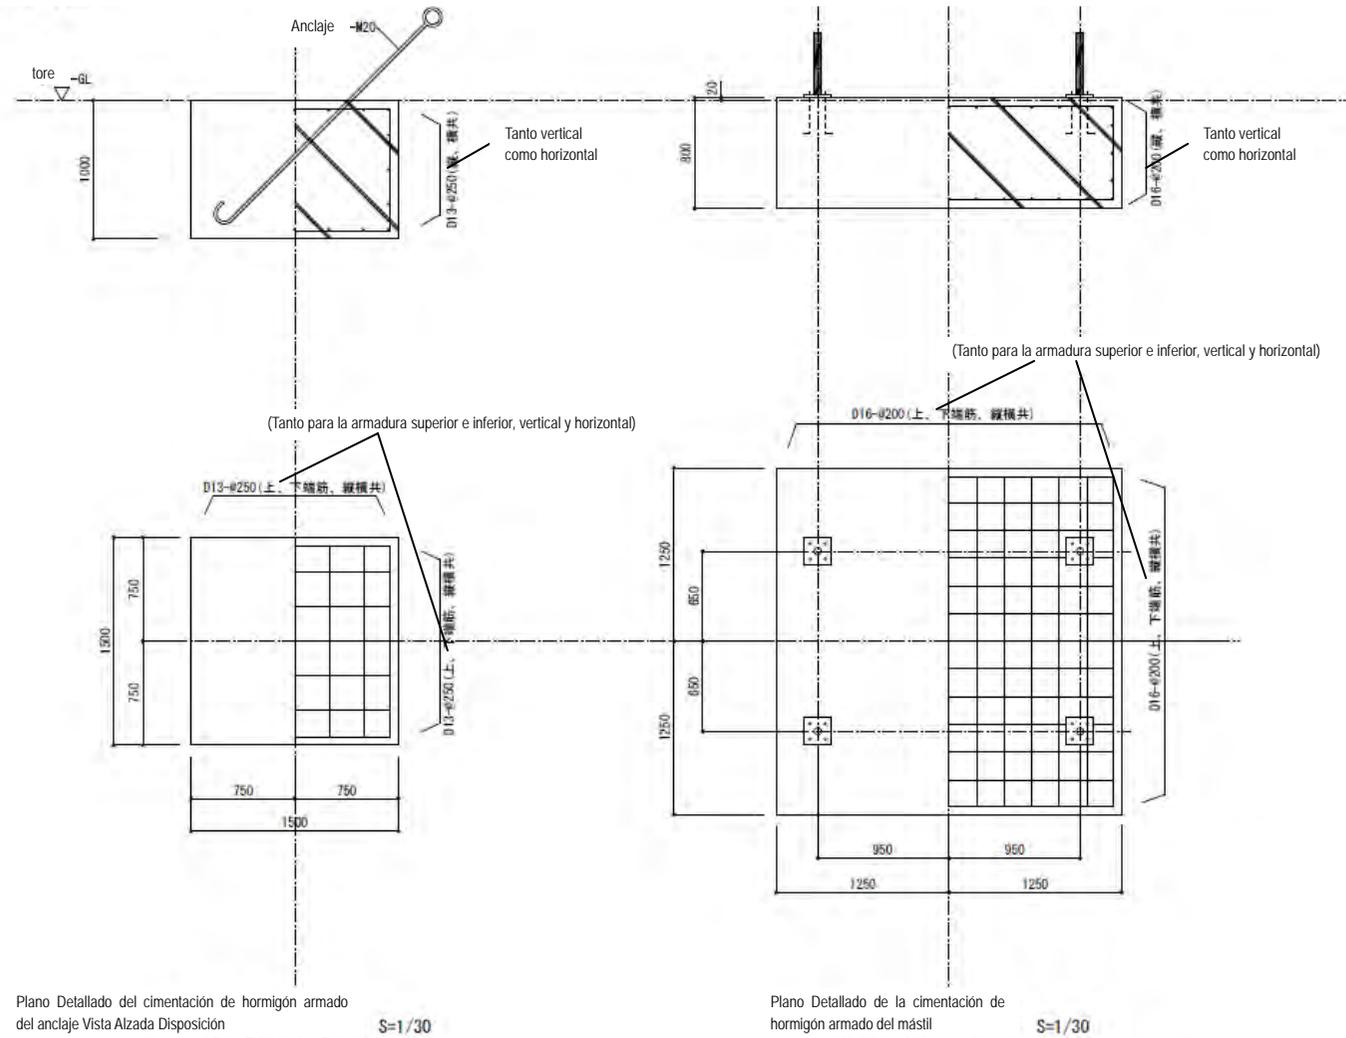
Plano de Cimentación de la Torre (h=30m) (plano referencial)
